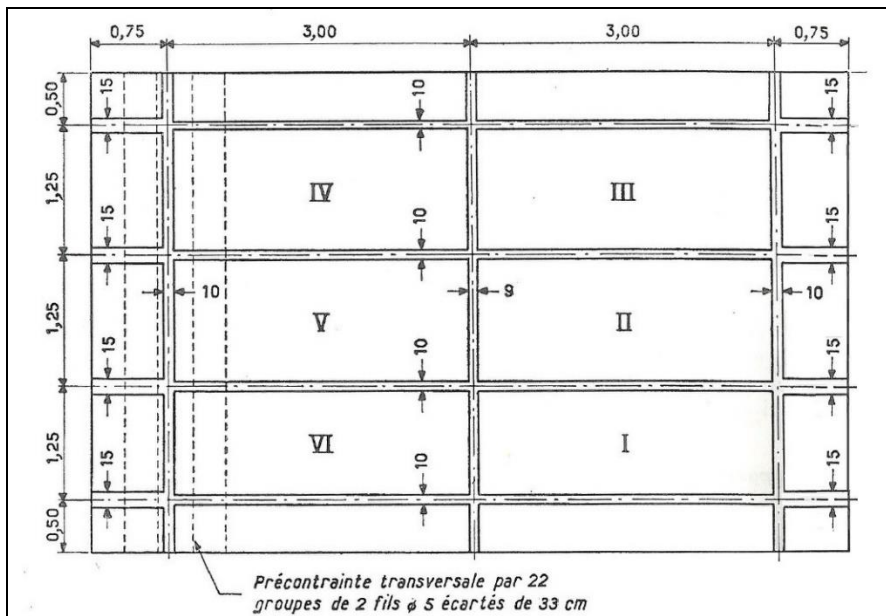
Configuration testée par Y. Guyon – Vue en plan
